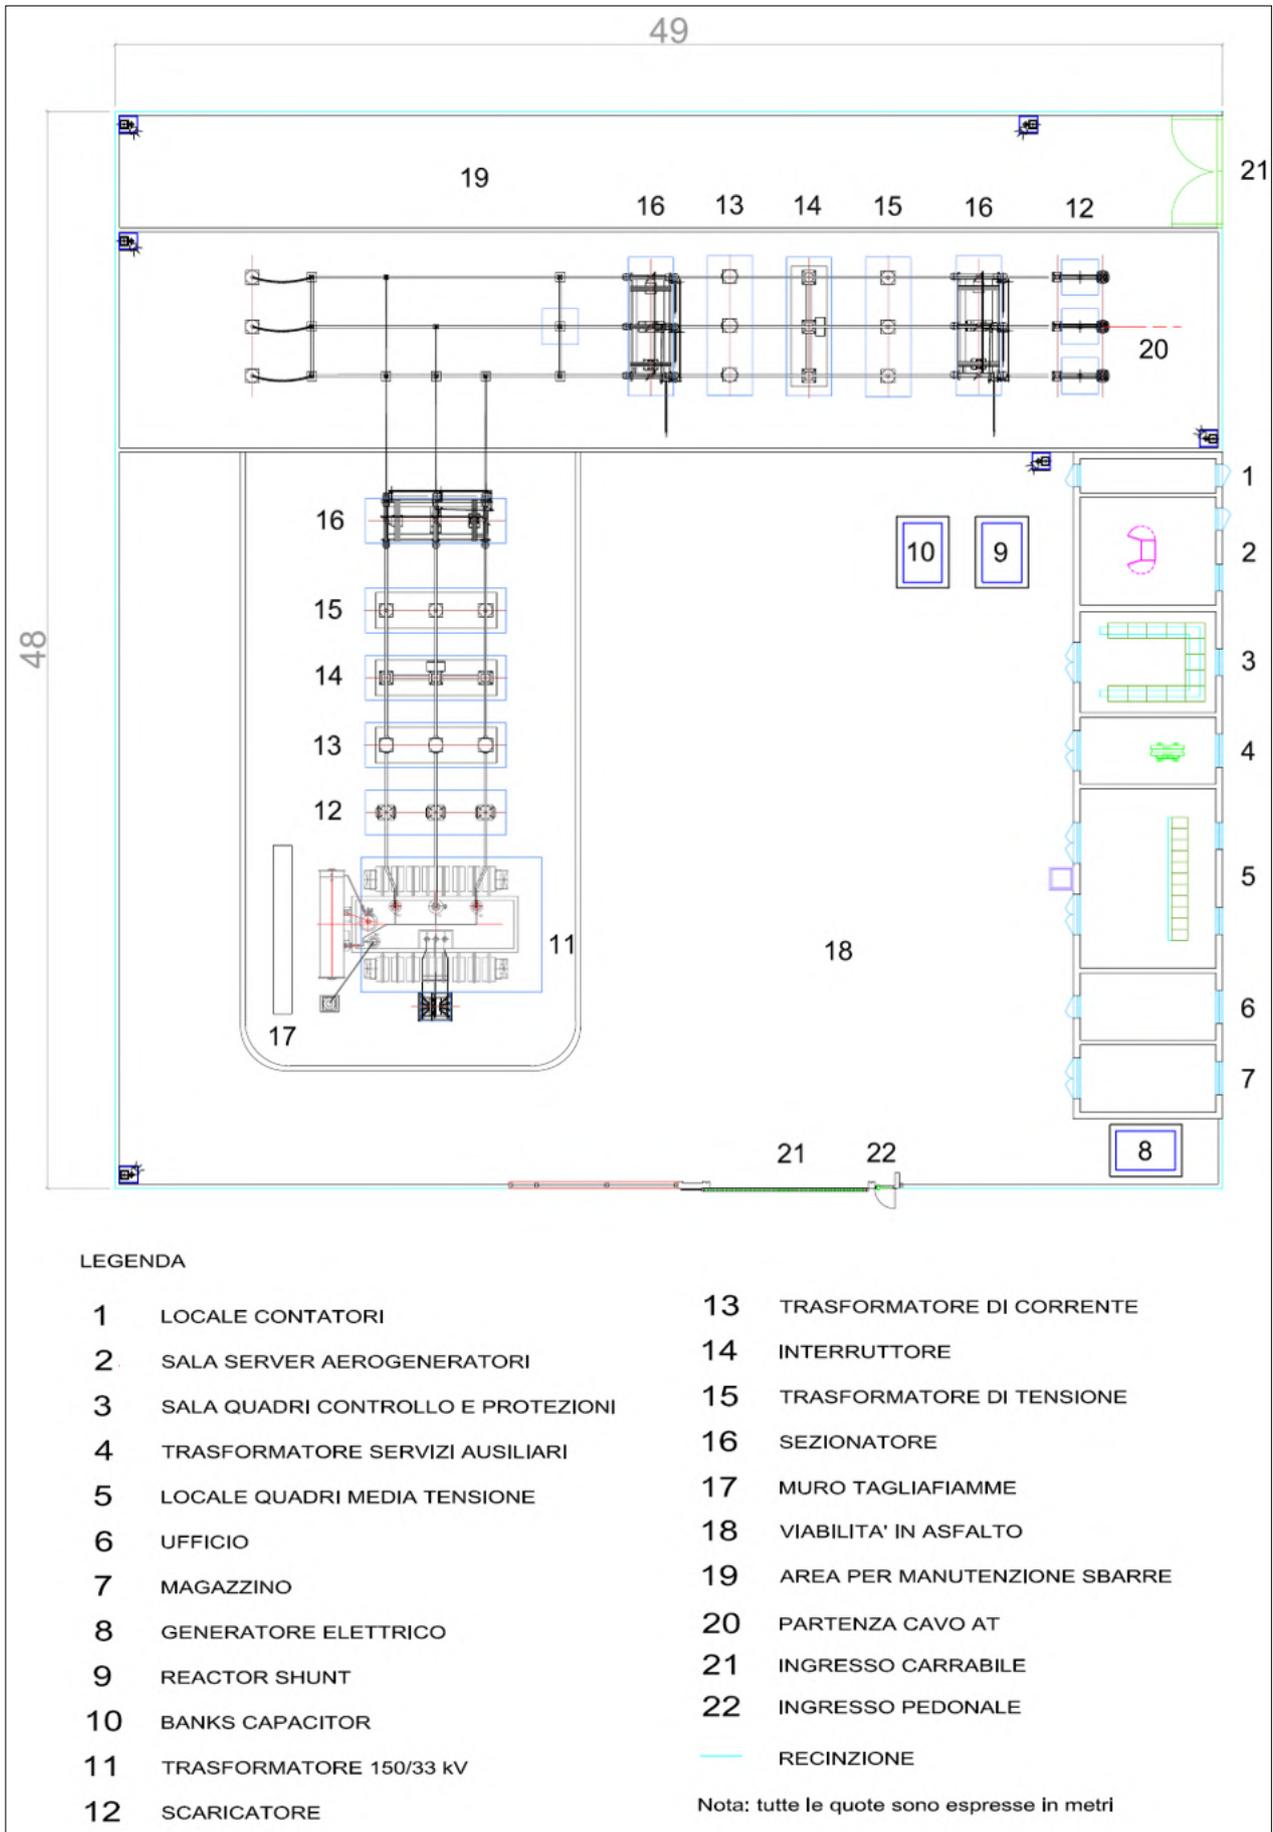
Planimetria elettromeccanica della Stazione Elettrica Utente 150/33 kV
